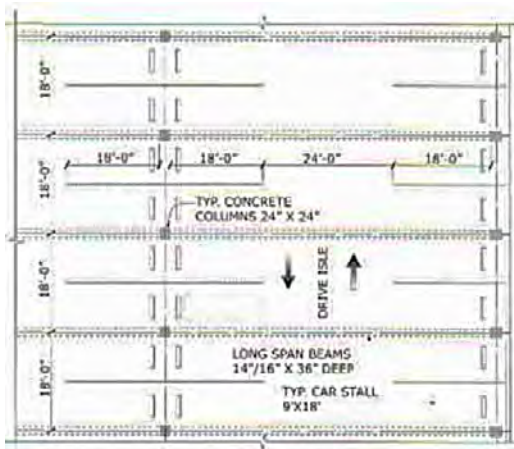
План паркинга с большими пролетами (Long-Span Parking Structures) [10]
